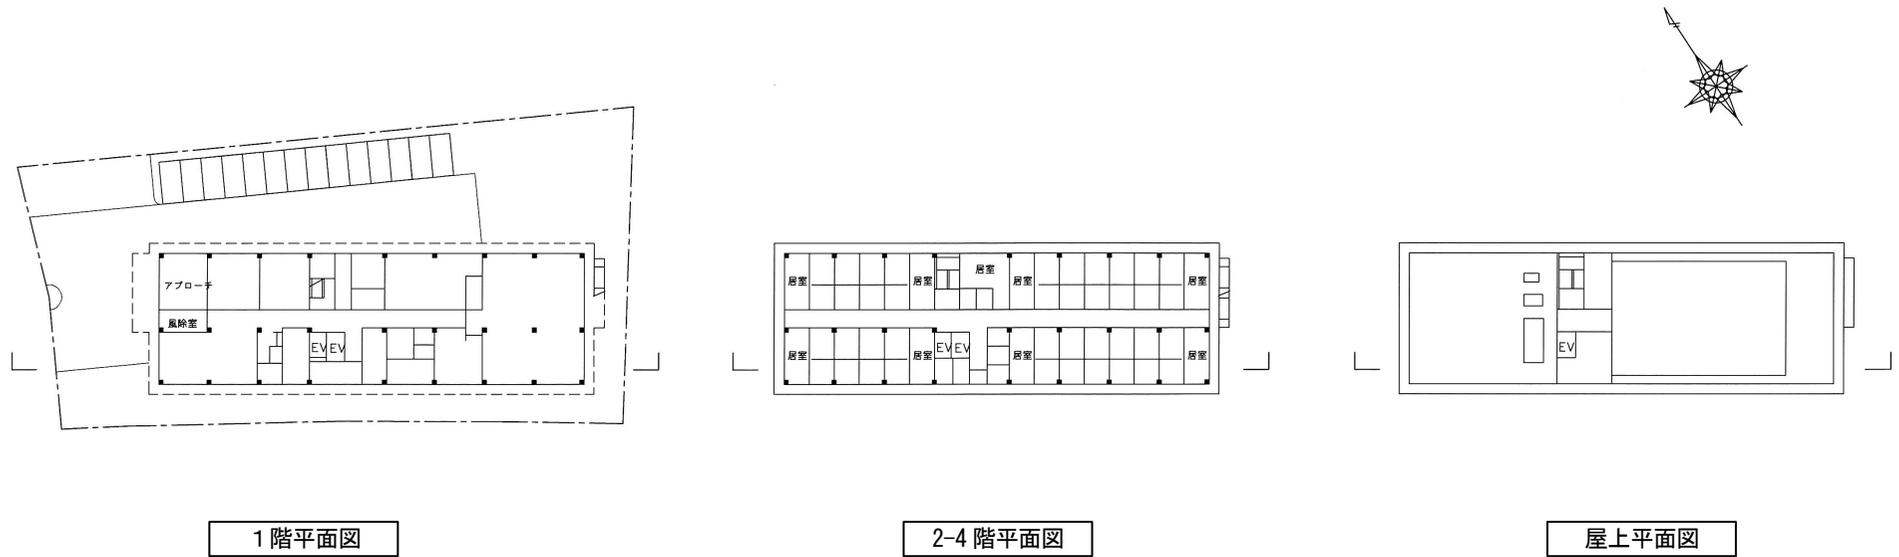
(1) 施設平面図（住宅型有料老人ホーム）
